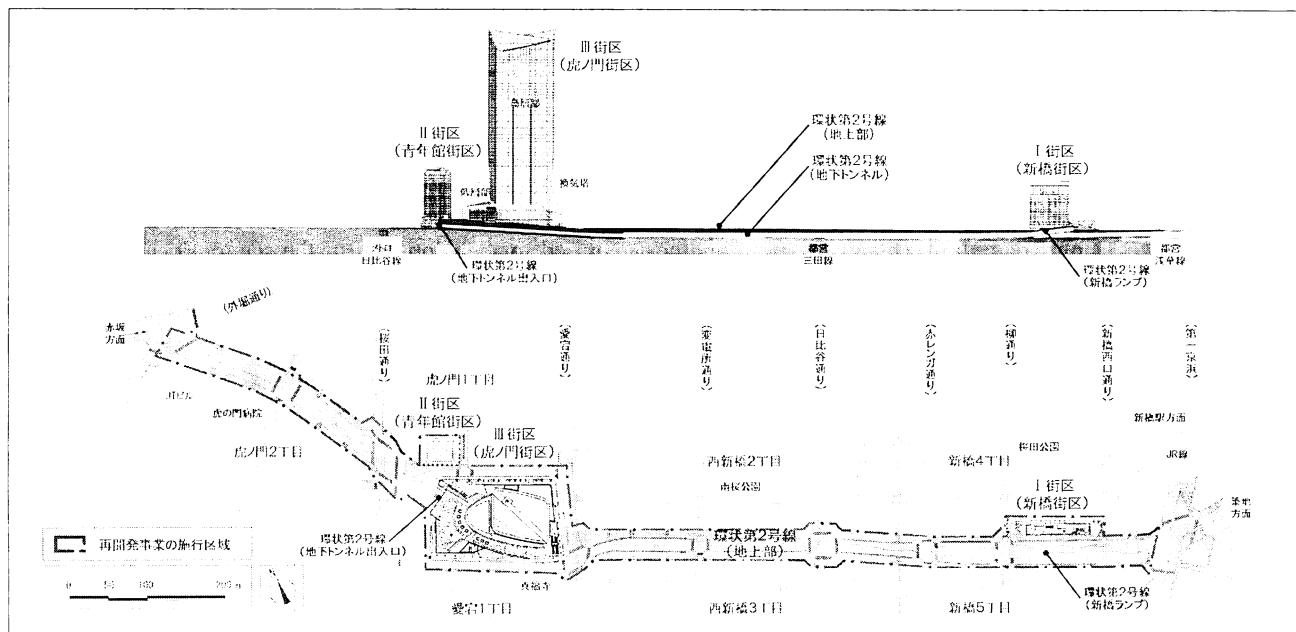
環状第二号線新橋・虎ノ門地区市街地再開発事業の平面図と断面図
